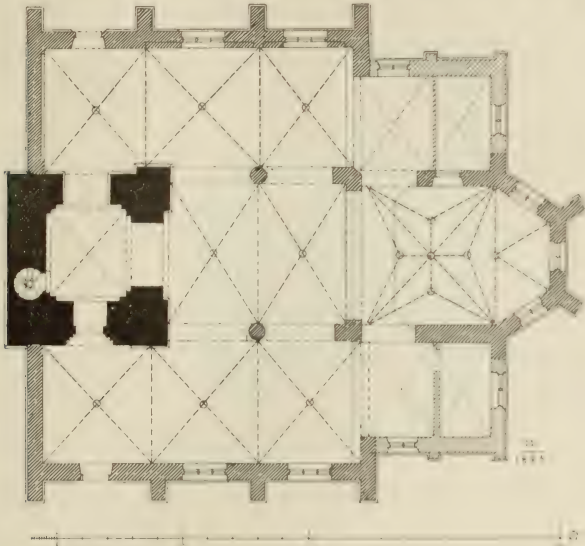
Oberembt. Grundriss der katholischen Pfarrkirche
